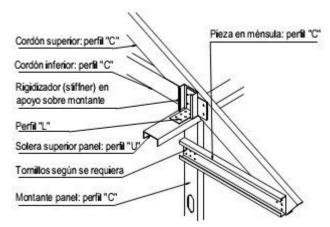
Detalle de unión de cabriada en el apoyo de pared liviana. Adaptado de Steel Framing Arquitectura, por Sarmanho Freitas, A., Mordes de Crastro, R. (2007).
